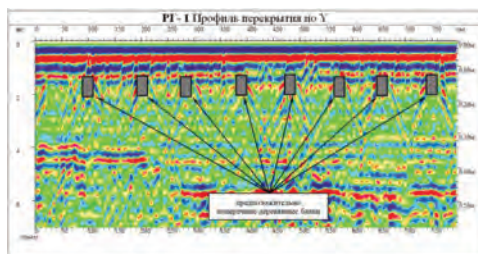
Радарограмма перекрытия 2 этажа здания
